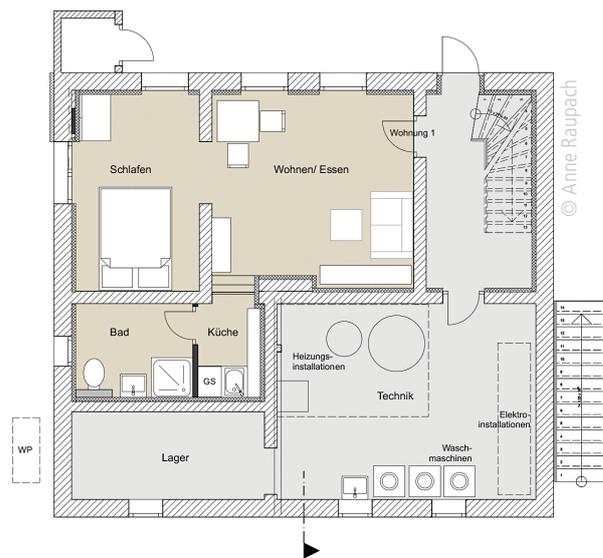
Grundriss Sockelgeschoss mit Einliegerwohnung und Technikräumen
